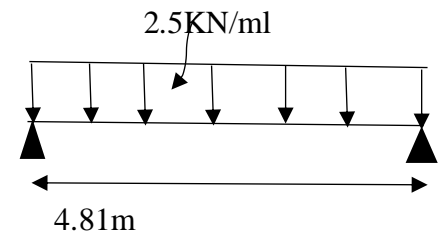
Schéma statique de la poutrelle et son chargement avant coulage de la dalle de compression.
